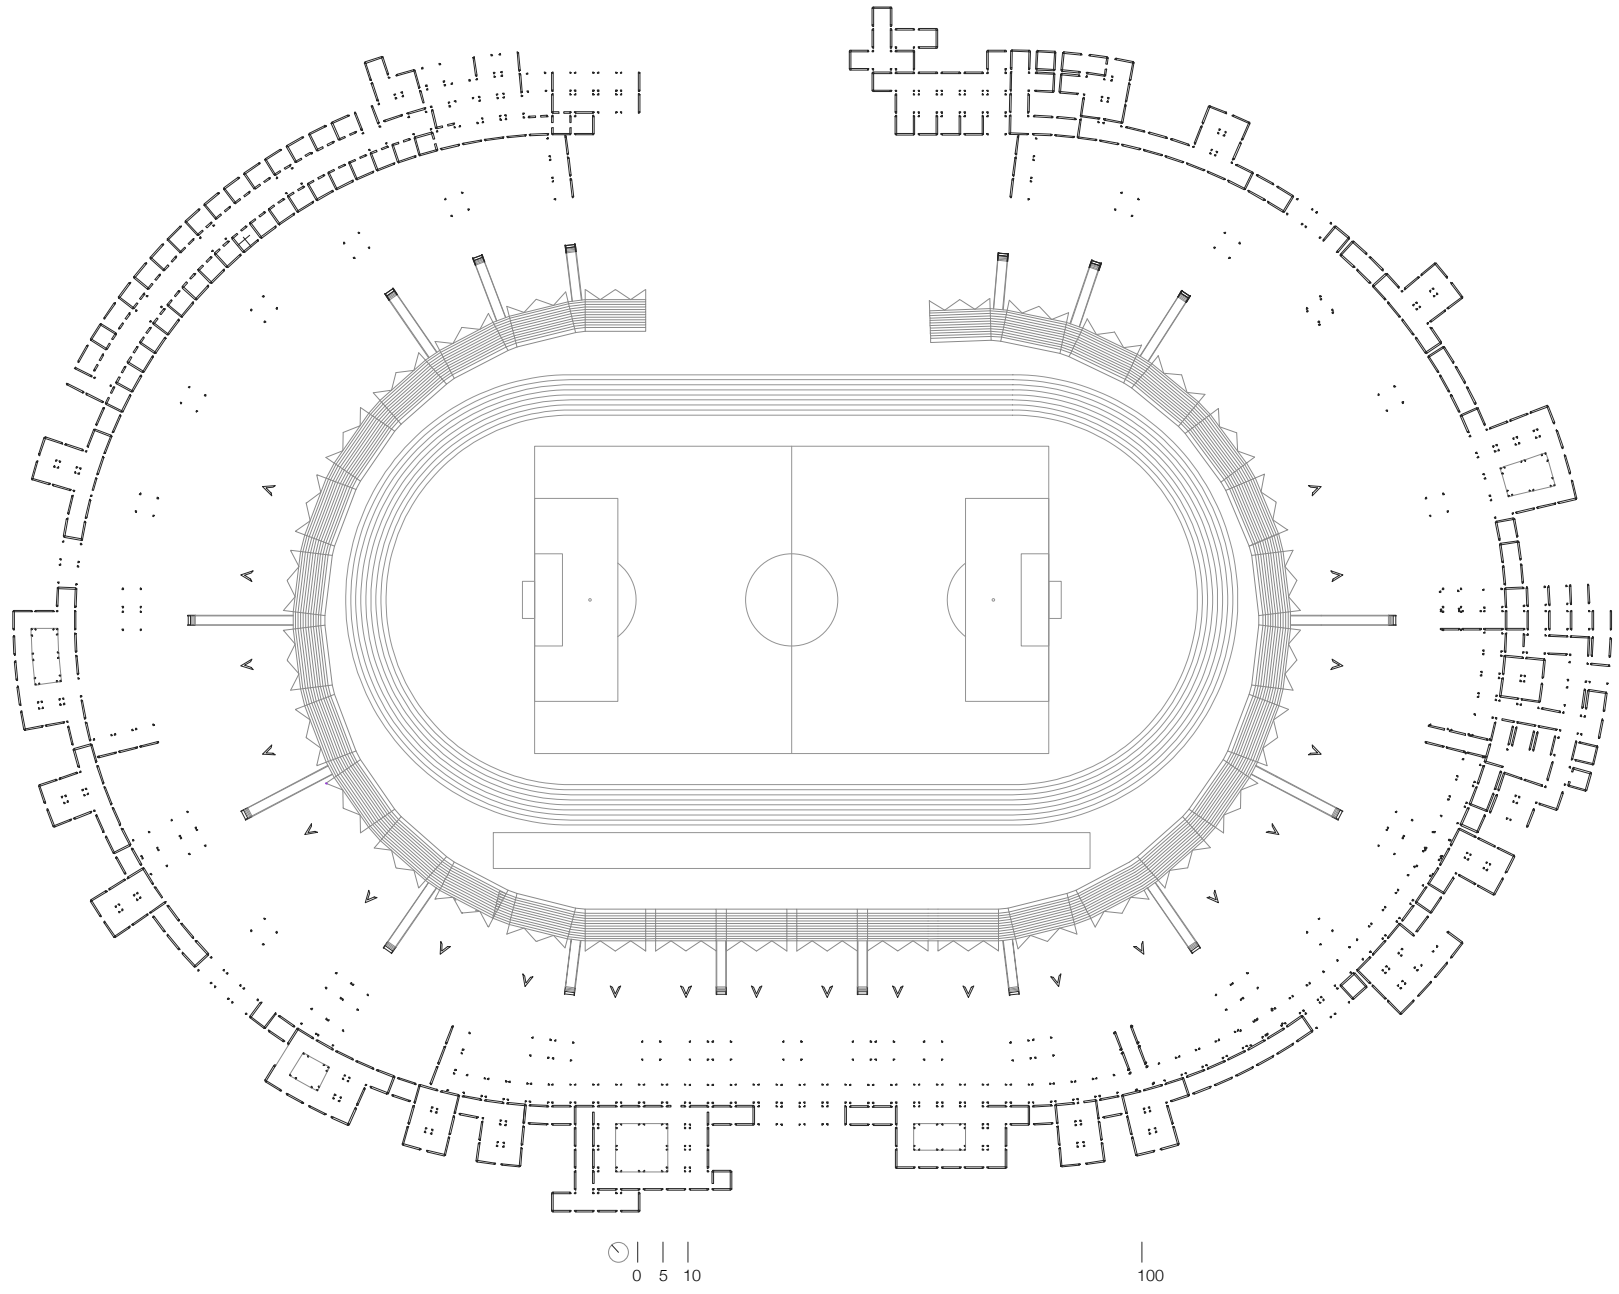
Planta baja +0.00 m. Acceso recinto.
